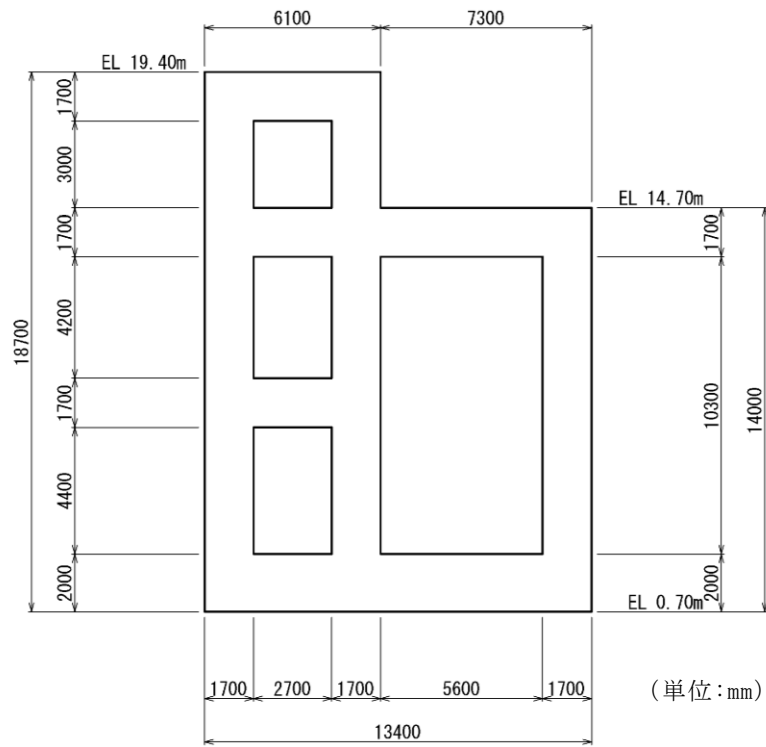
第 1 ベントフィルタ格納槽 断面図 (A-A 断面)
